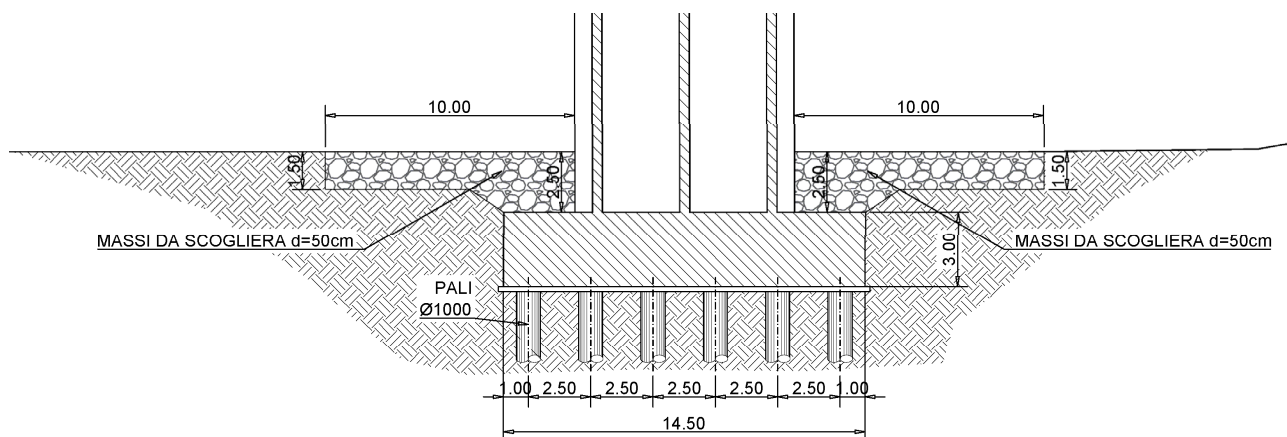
intervento di protezione delle pile P8-P9 – viadotto "T. Alvo"
